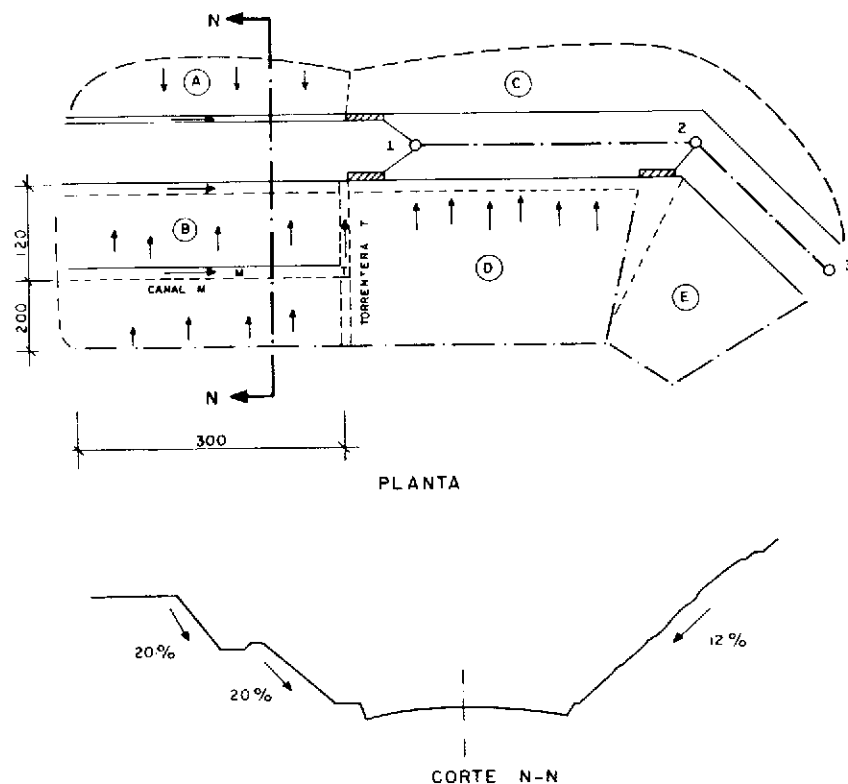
Planta y corte transversal del área de drenajes.
